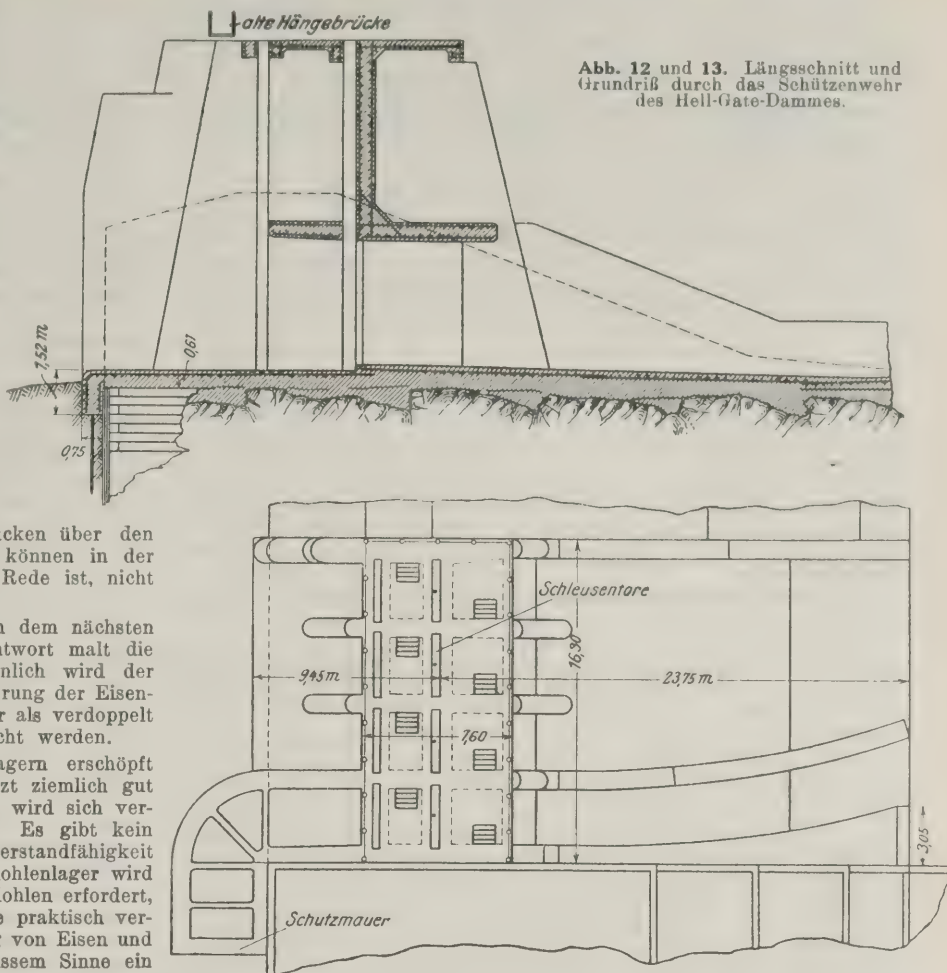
und 13. Längsschnitt und Grundriß durch das Schützenwehr des Hell-Gate-Dammes.
